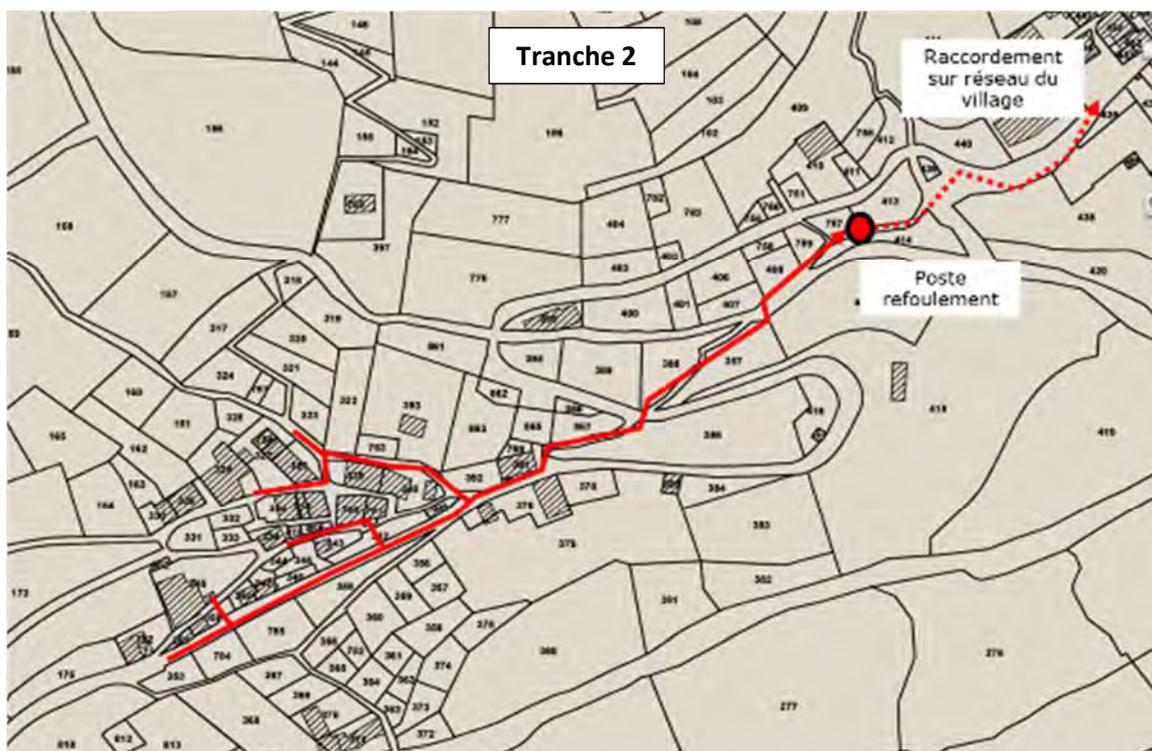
Plan de l'assainissement collectif sur Le Chambon
